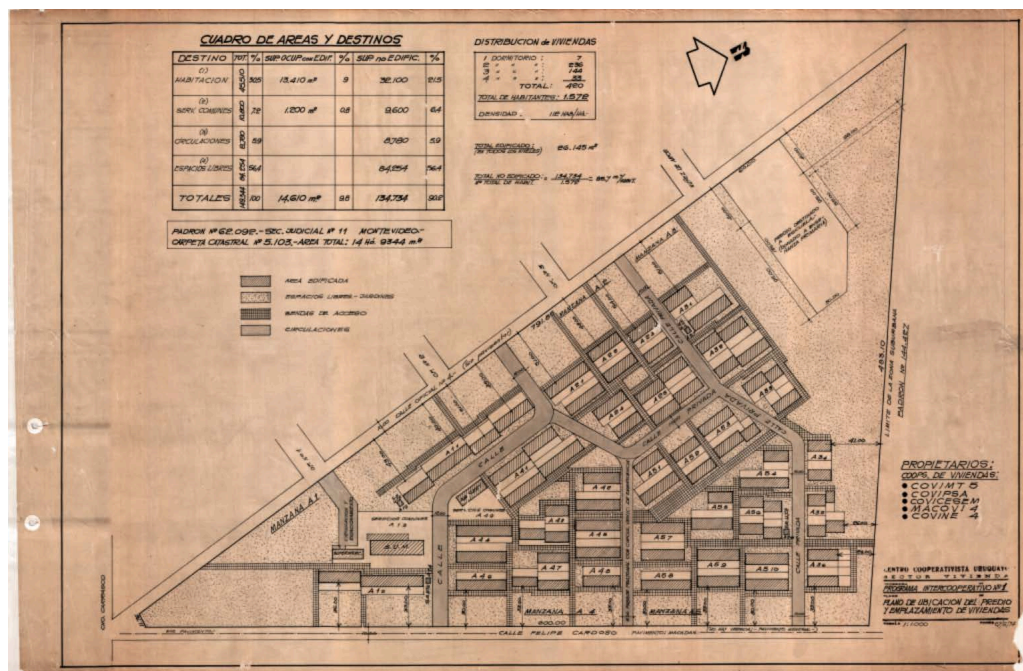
Conjunto nuevo amanecer: Planta General (D.0182), CCU, 1975. Fuente: DDI, IH, FADU- UdelAR.
